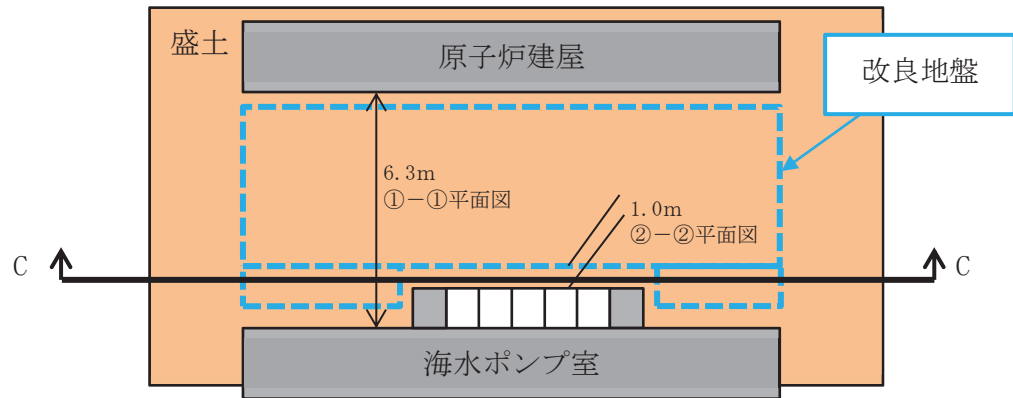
海水ポンプ室～原子炉建屋間の模式平面図
